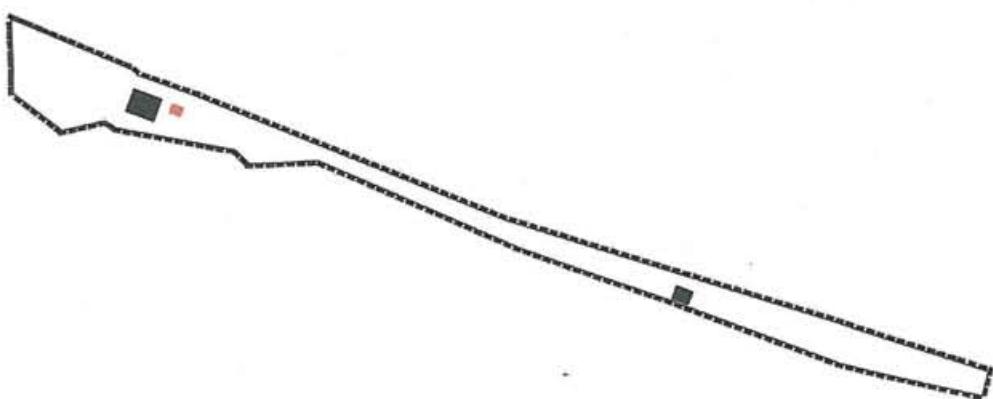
Vergleich Bestandsgebäude (schwarz) und Planung (rot)
